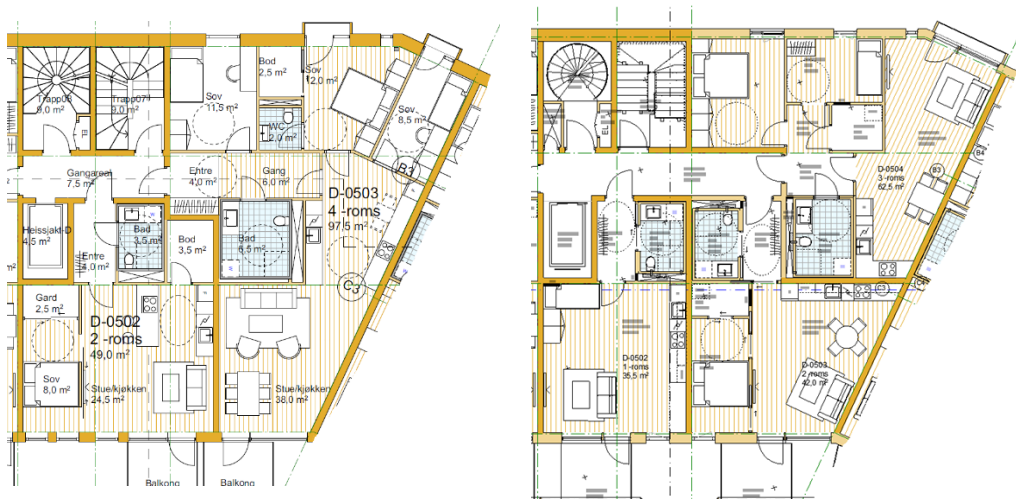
Gjeldende plankart til venstre og plankart etter planendring til høyre
